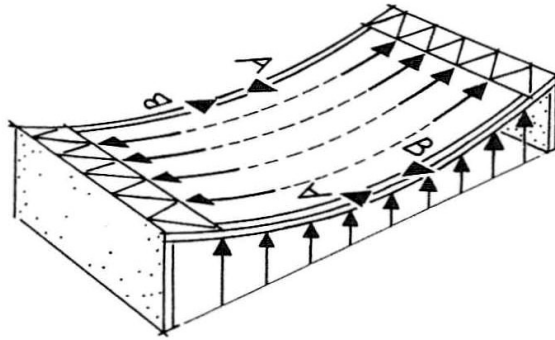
Kräfteverlauf in einem geschlossenen Randverankerungssystem über rechteckigem Grundriss mit gekrümmtem Druckbalken [Siegel 1960]
